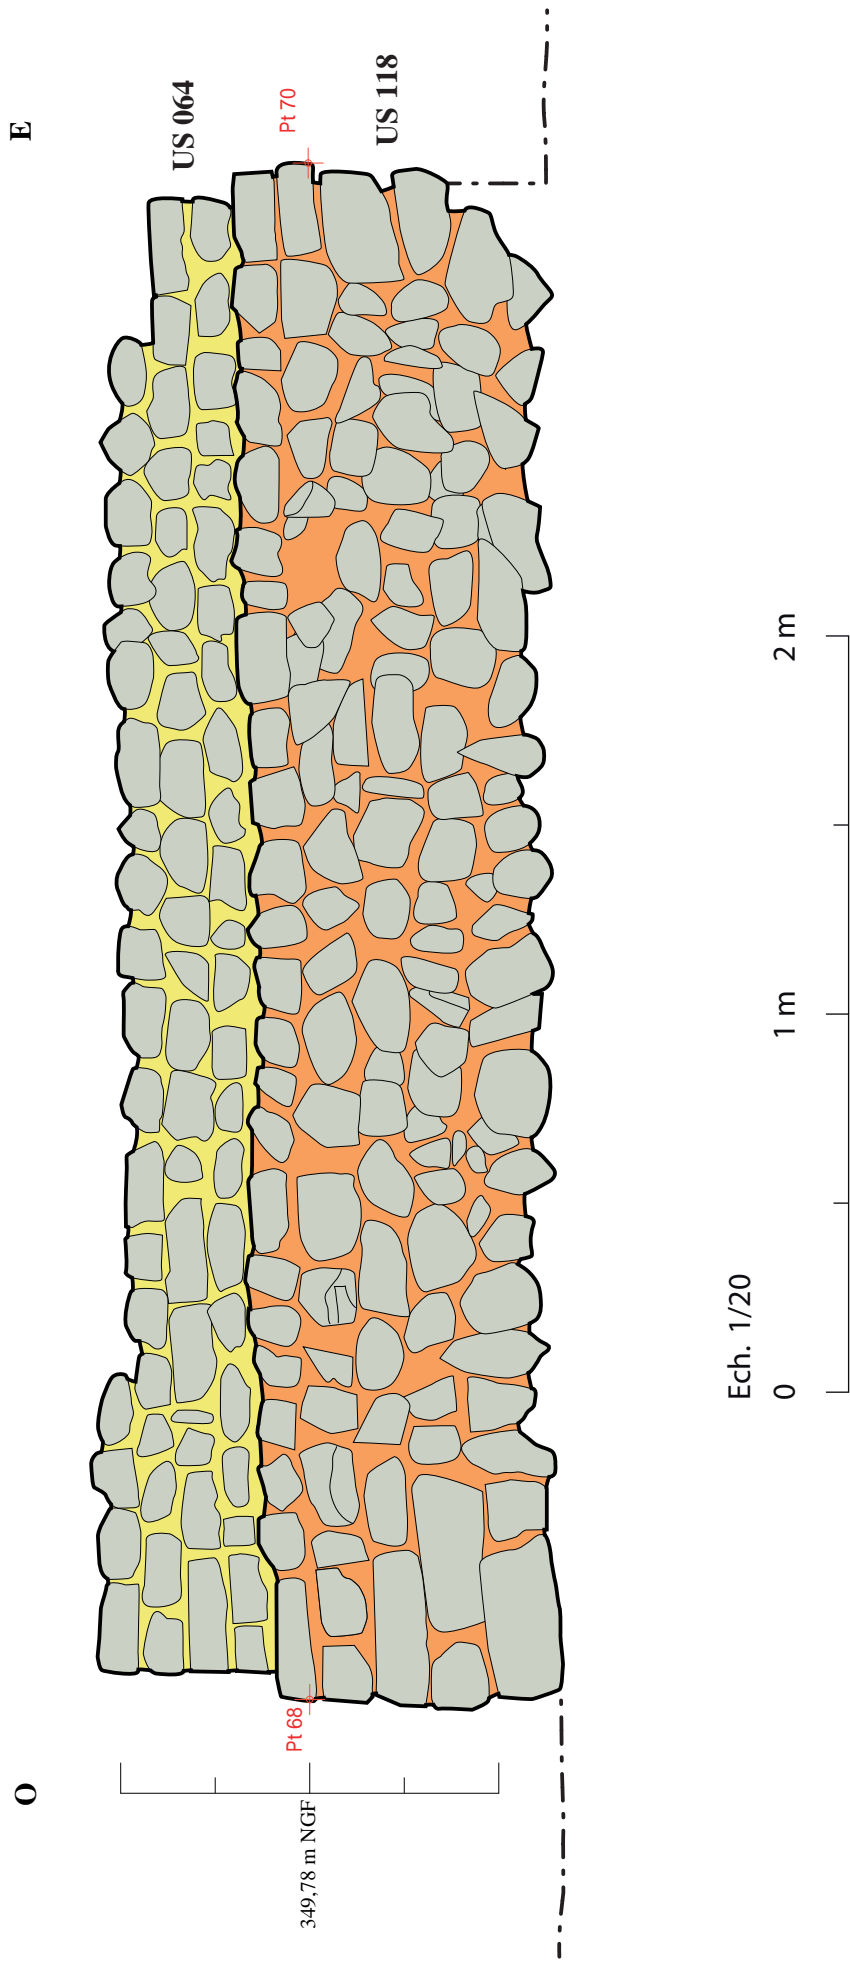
Elévation et fondation du mur MR064 du bâtiment ENS 2.
